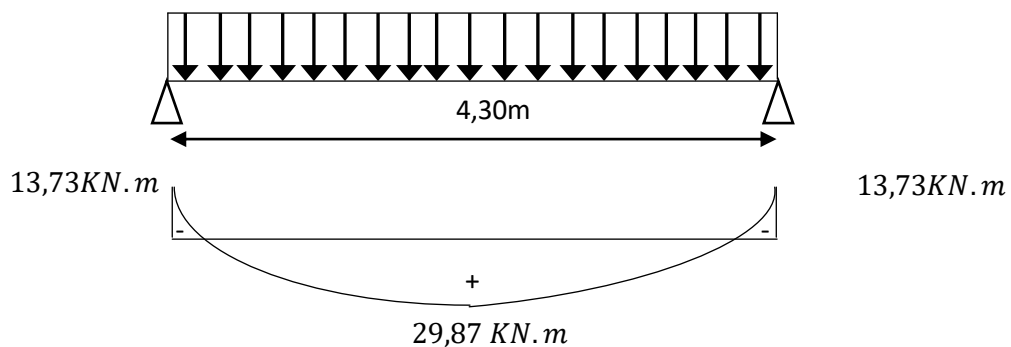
Schéma statique de la poutre palière de l'escalier
